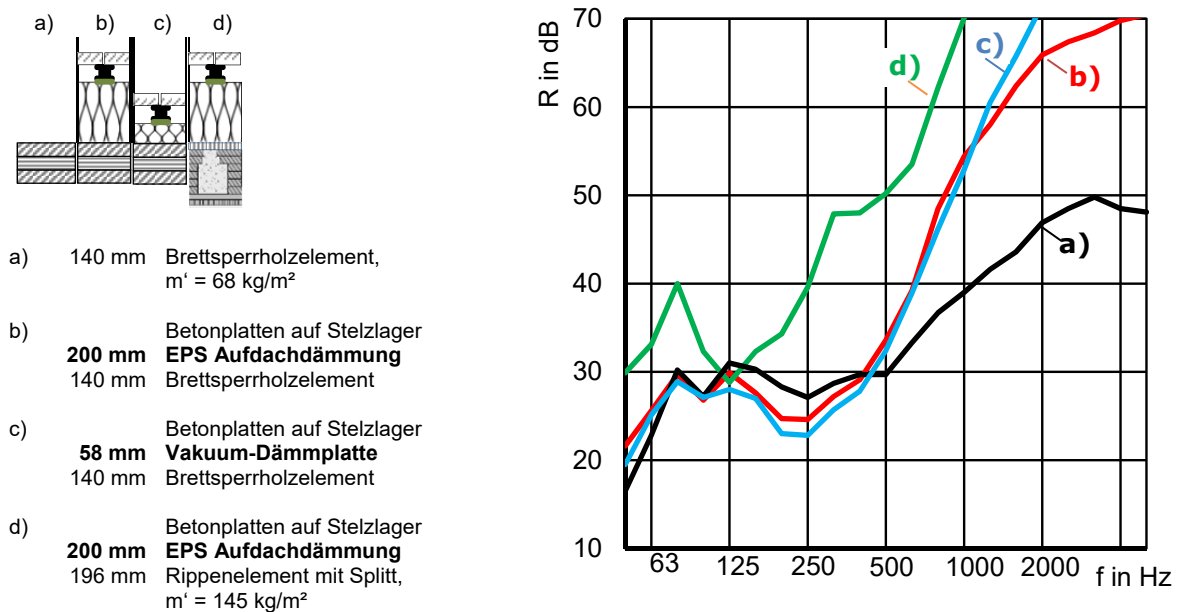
Einfluss der Aufdachdämmung auf das Schalldämm-Maß von Flachdachaufbauten. Der Aufbau oberhalb der Dämmplatte (hier: 40 mm Betonplatten, Stelzlager, Baulager, Dachabdichtung) ist für die Luftschallübertragung auf Grund der Fugen zwischen den Betonplatten nicht maßgebend.
